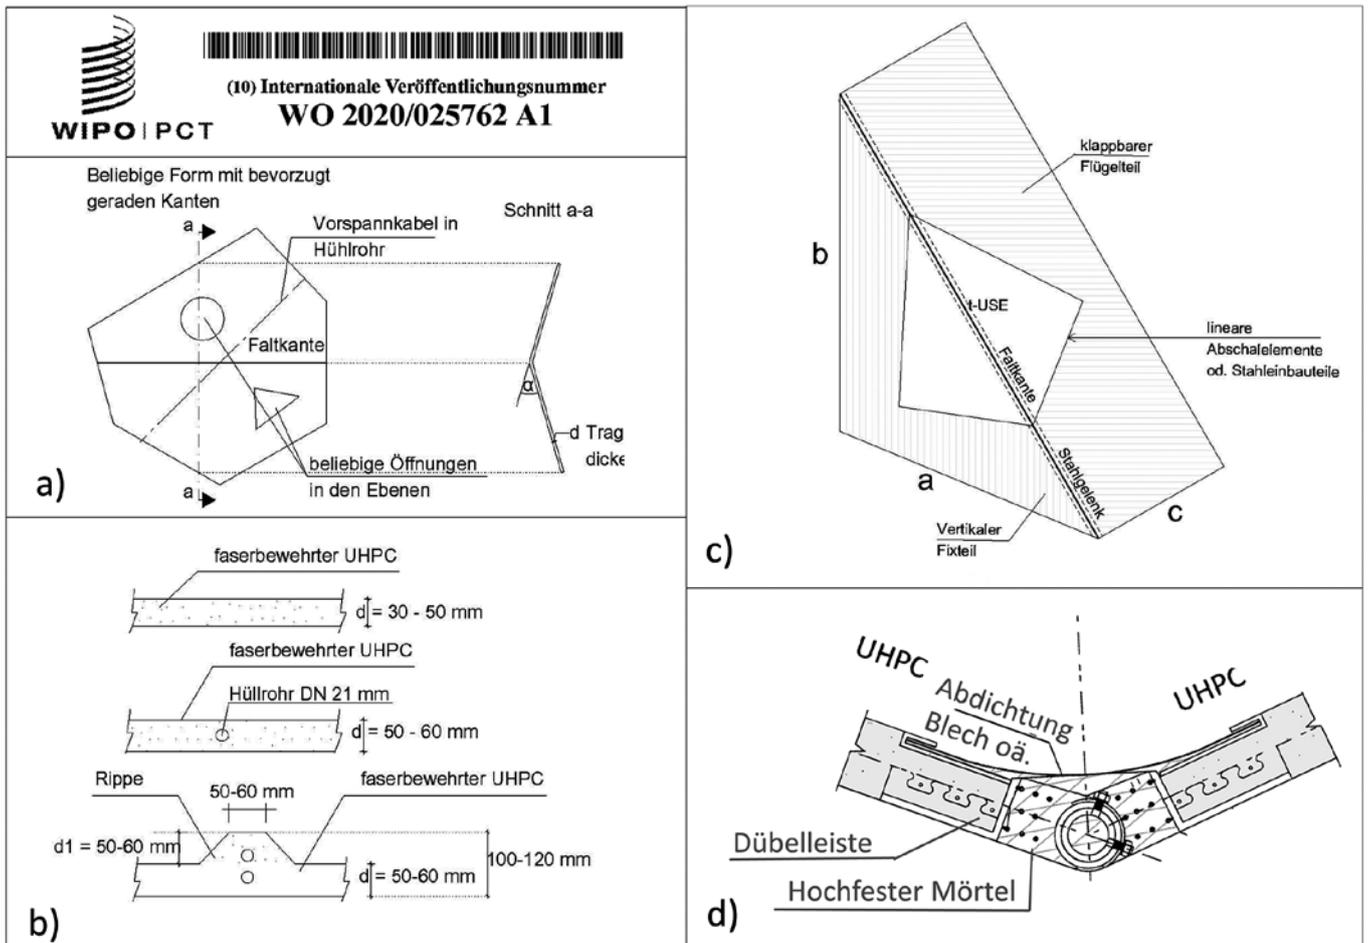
Basiselement a) Grundriss und Schnitt, b) Querschnittsformen, c) Schaltisch für Serienproduktion, d) flexibler Regelanschluss
